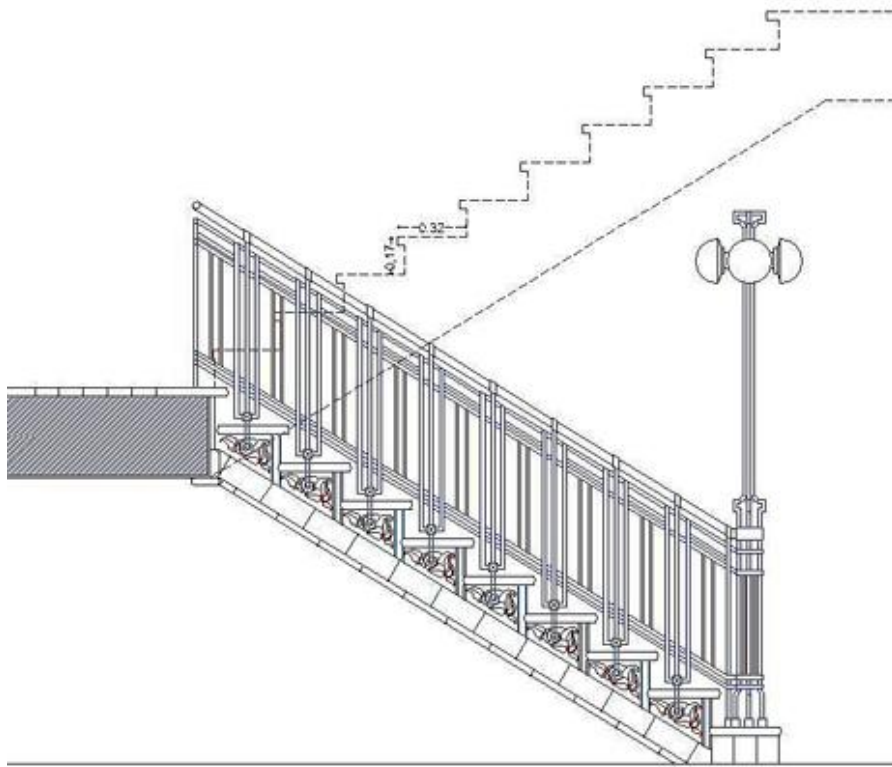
Alzado primer tramo de escalera. Núcleo escaleras torreón izquierdo.
